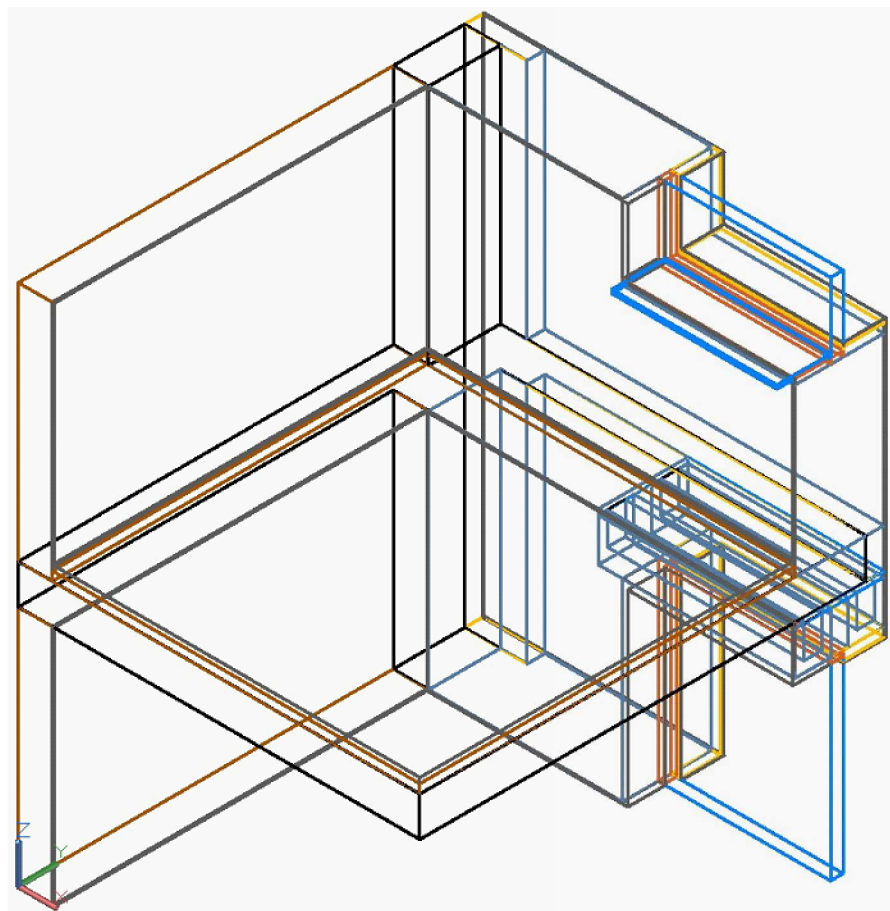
Расчетная схема узла углового сопряжения наружной стены квартиры в уровне перекрытия
